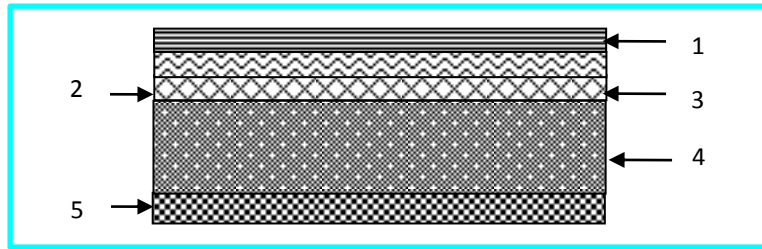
Coupe transversale dans le plancher à dalle pleine.
